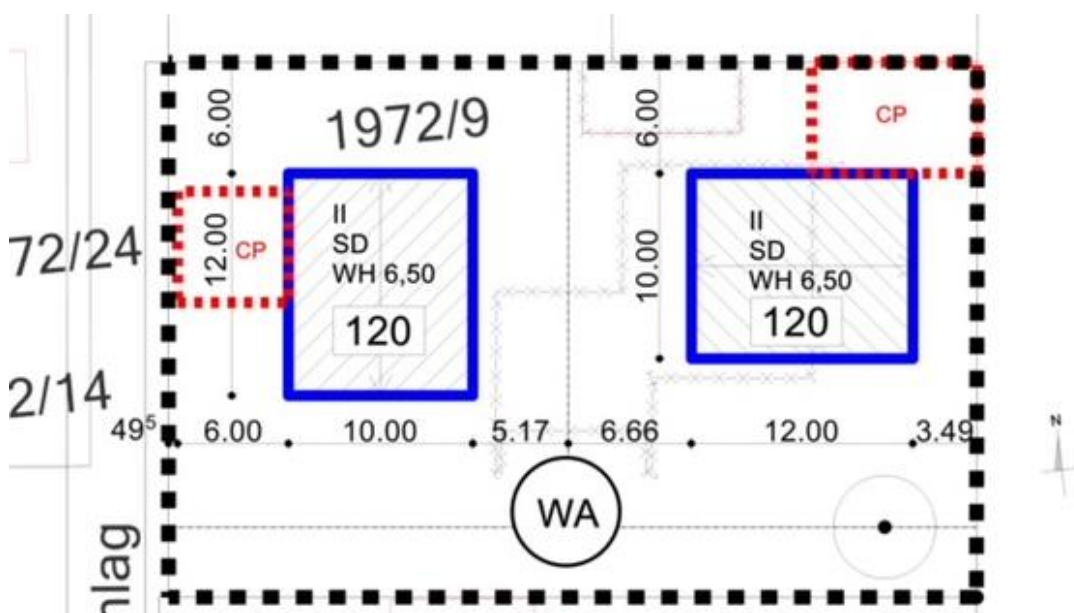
Lageplan, Quelle: Regnauer Hausbau GmbH & Co.KG,
